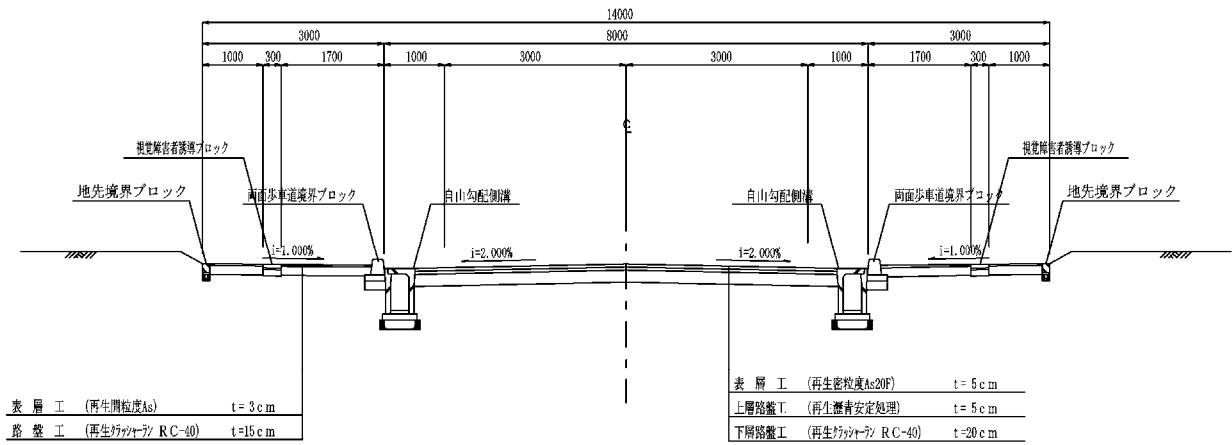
(2) 道路標準断面図(補助幹線道路:14m)
